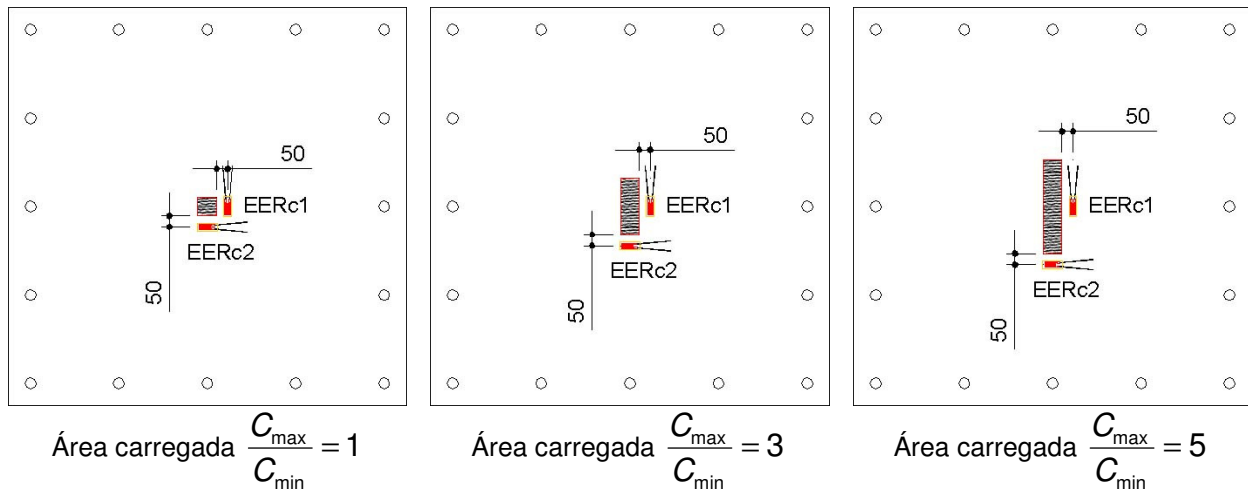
Disposição dos EERs na face inferior das lajes
